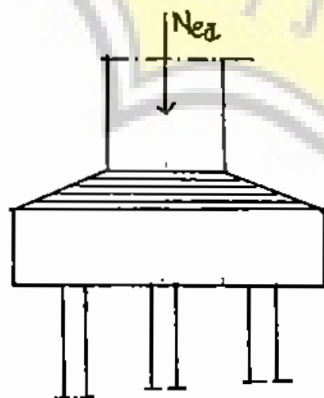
a. Denah Pondasi Tiang Pancang Pilar (*Pier*)
